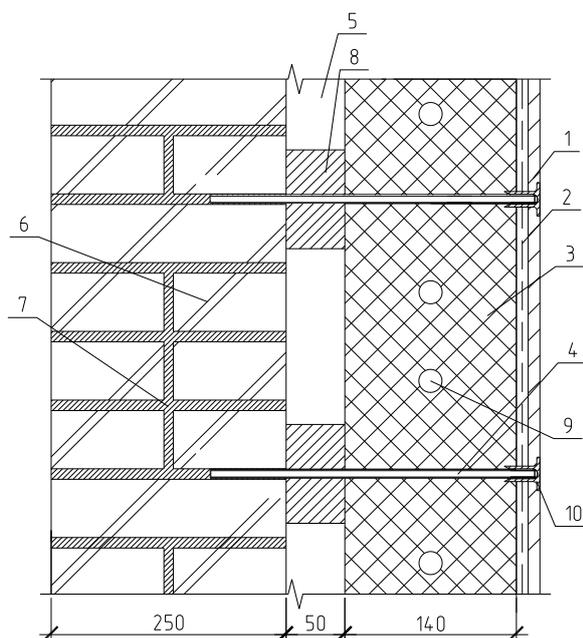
Конструктивное решение наружного стенового ограждения «Термический экран»
